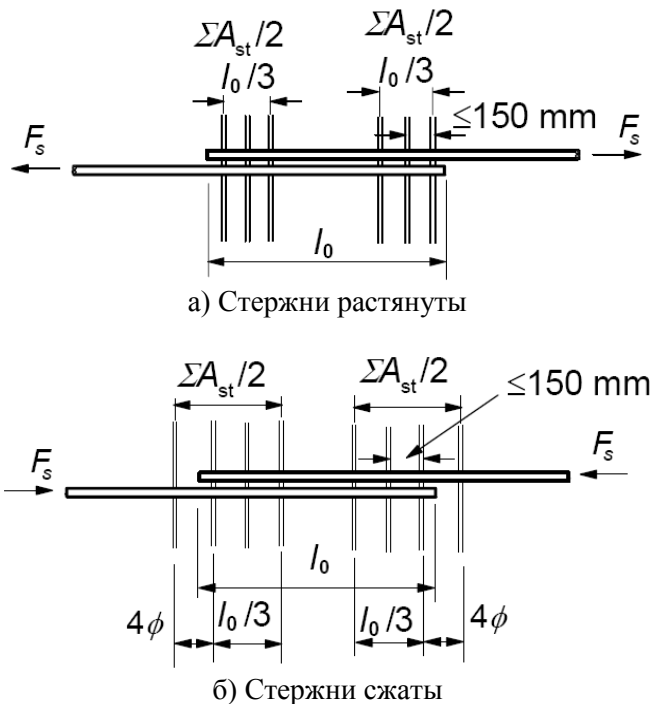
Поперечное армирование для соединений внахлестку
